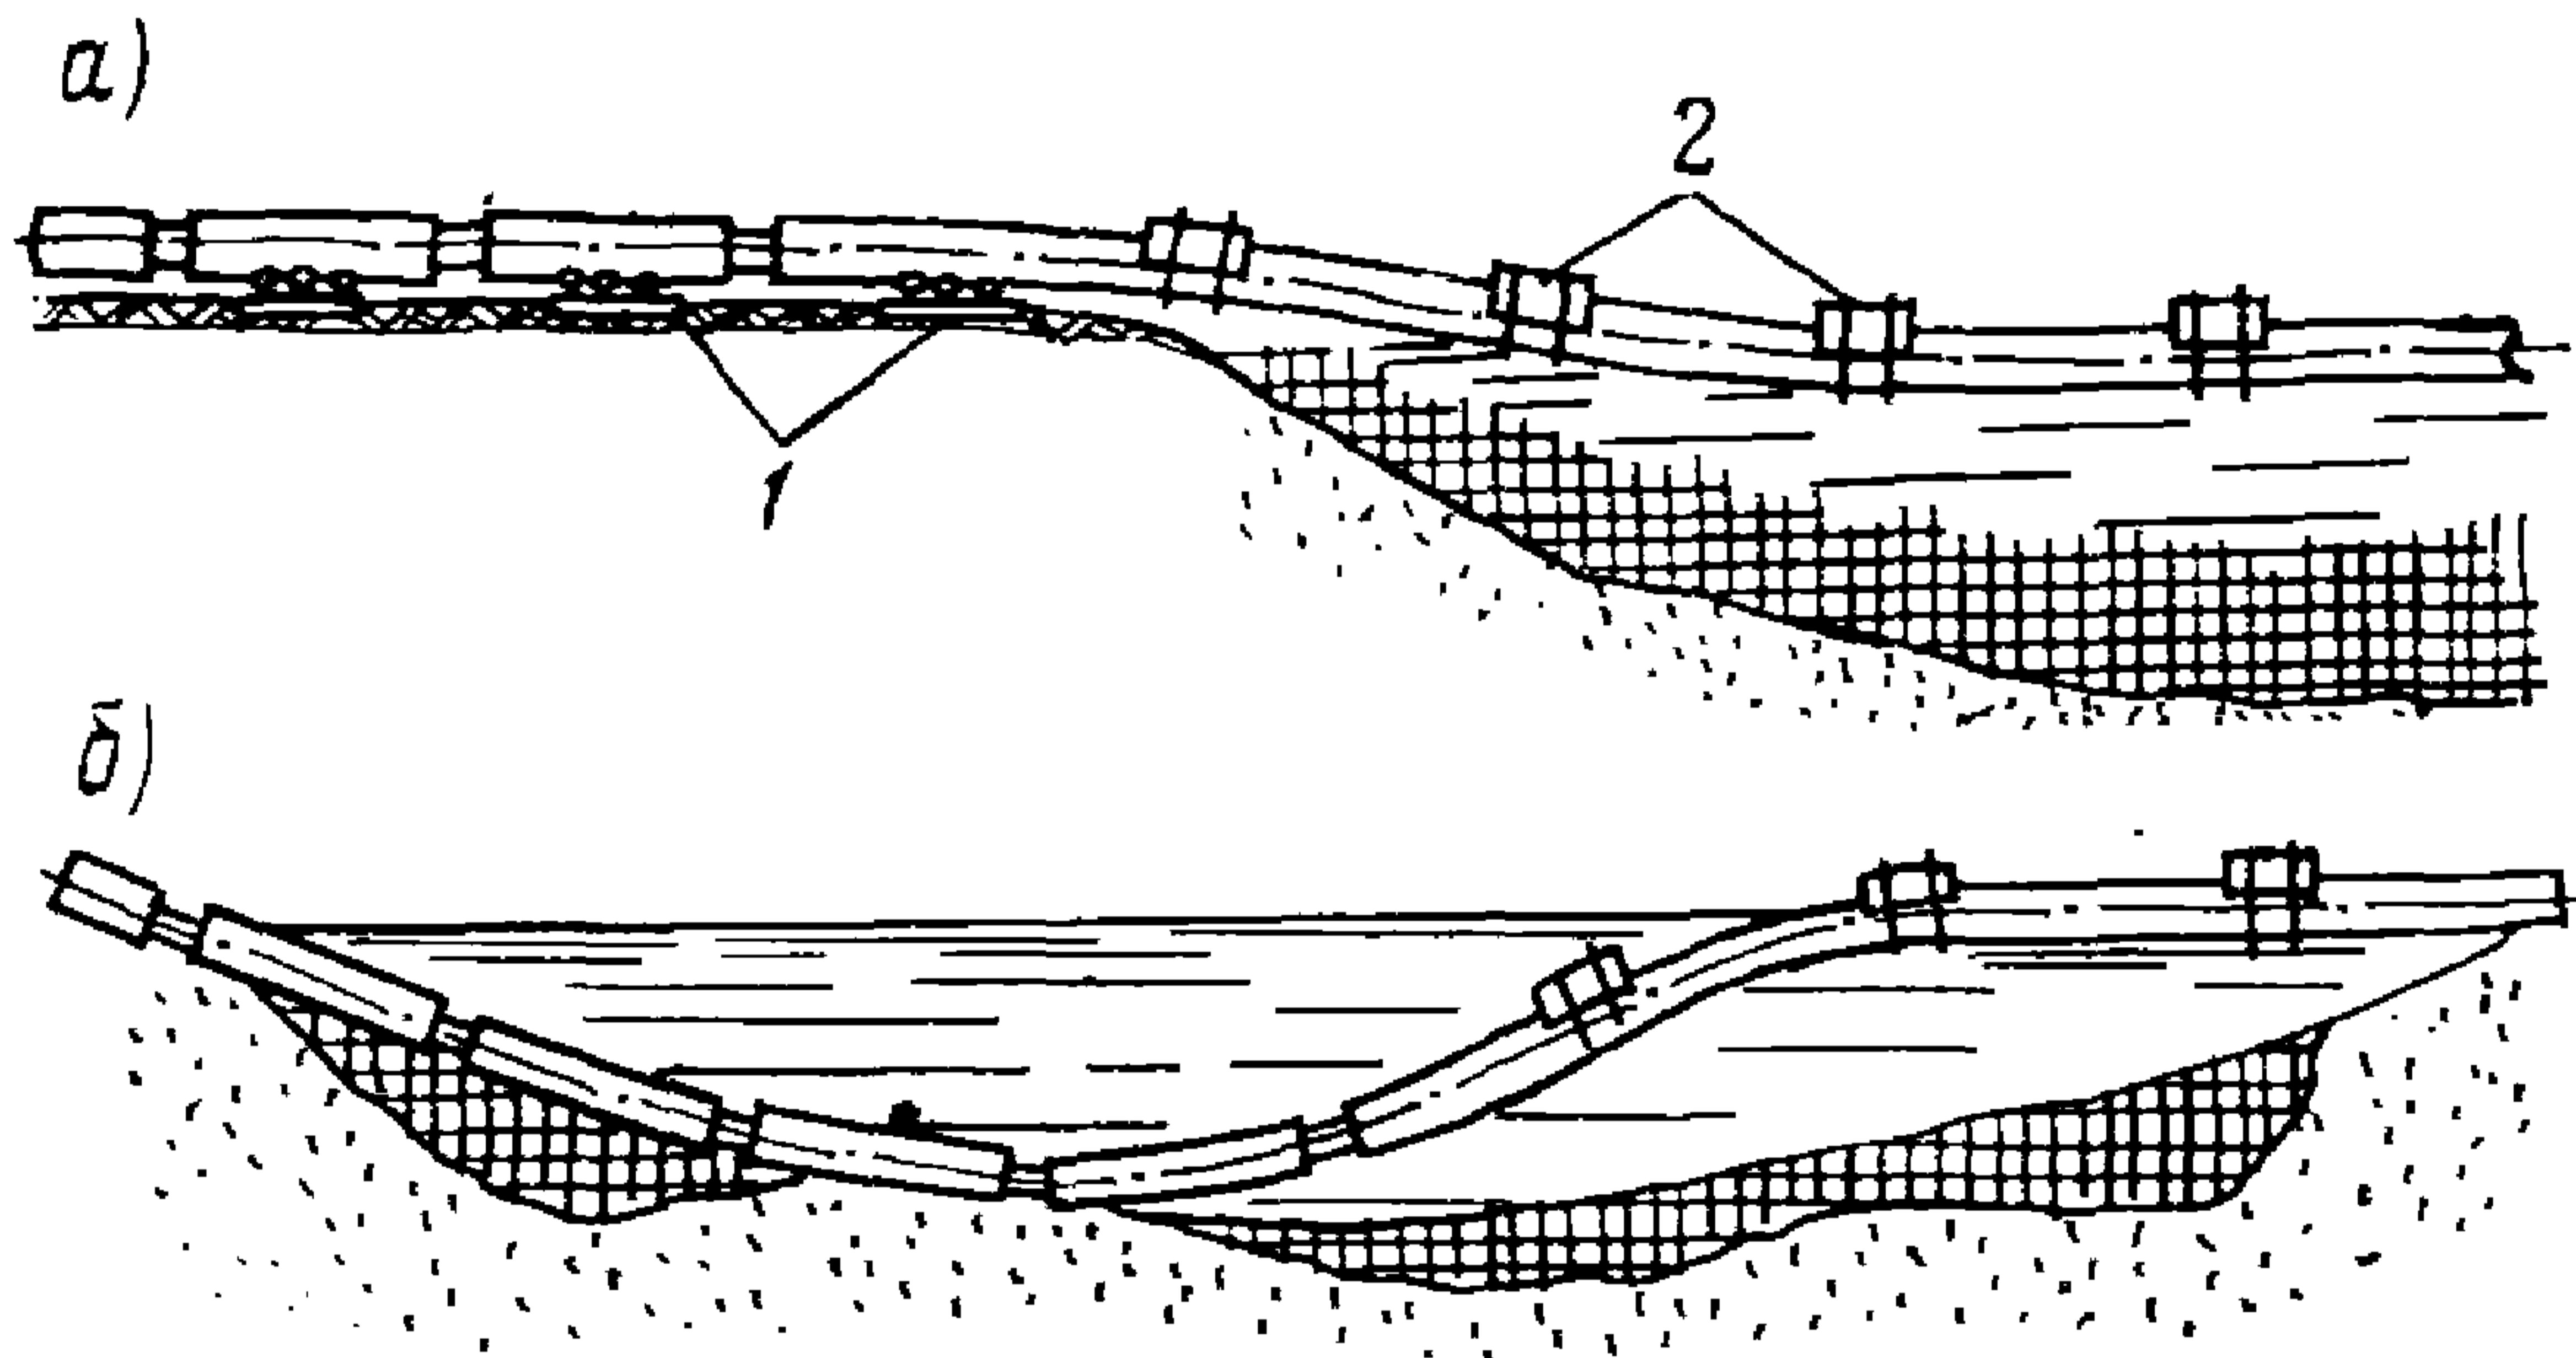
Укладка трубопровода методом сплава в канал, образованный взрывом:
